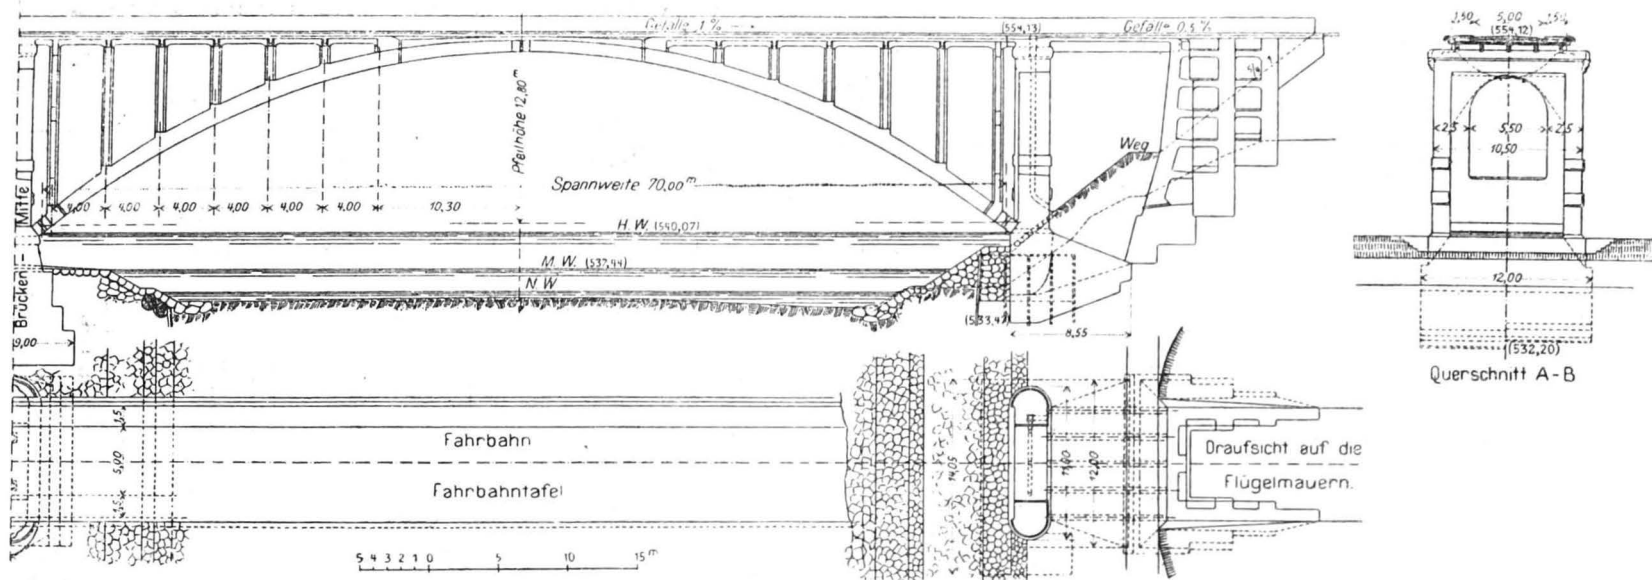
Secție longitudinală, transversală și plan a podului peste Isar lângă Grünwald. Jumătatea din dreapta.
